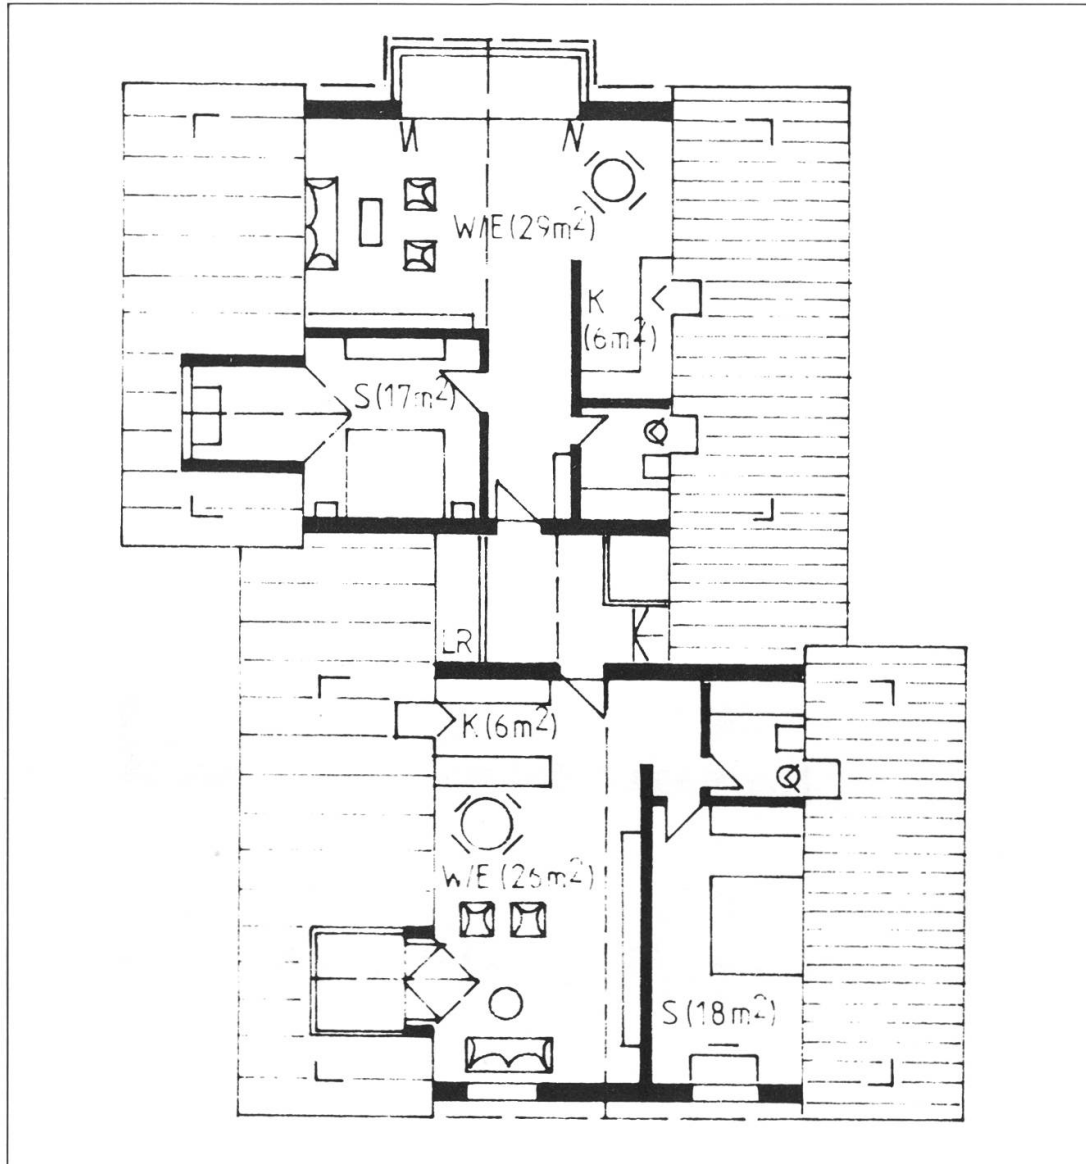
2-Zimmerwohnung Dachgeschoß laut Vorprojekt mit 60 m²
